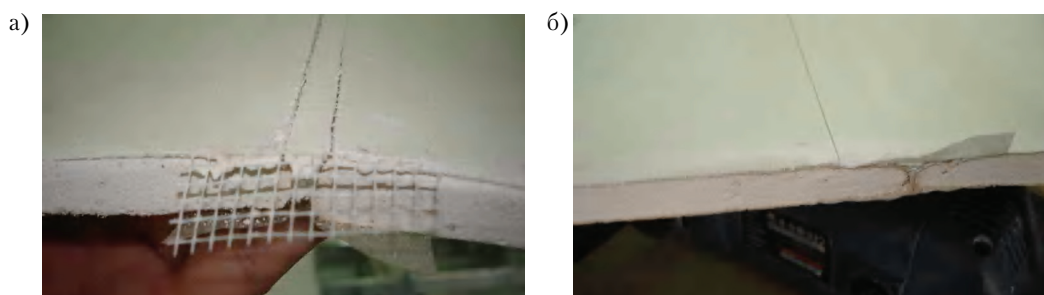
Характер разрушения стыков при армировании сетчатой лентой (а) и бумажной лентой (б).
